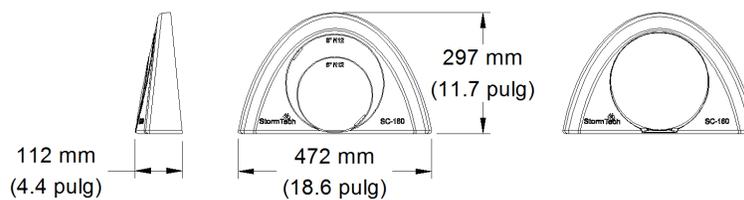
Dimensiones de la tapa SC-160LP y guías de corte para insertar tubos de entrada o salida
